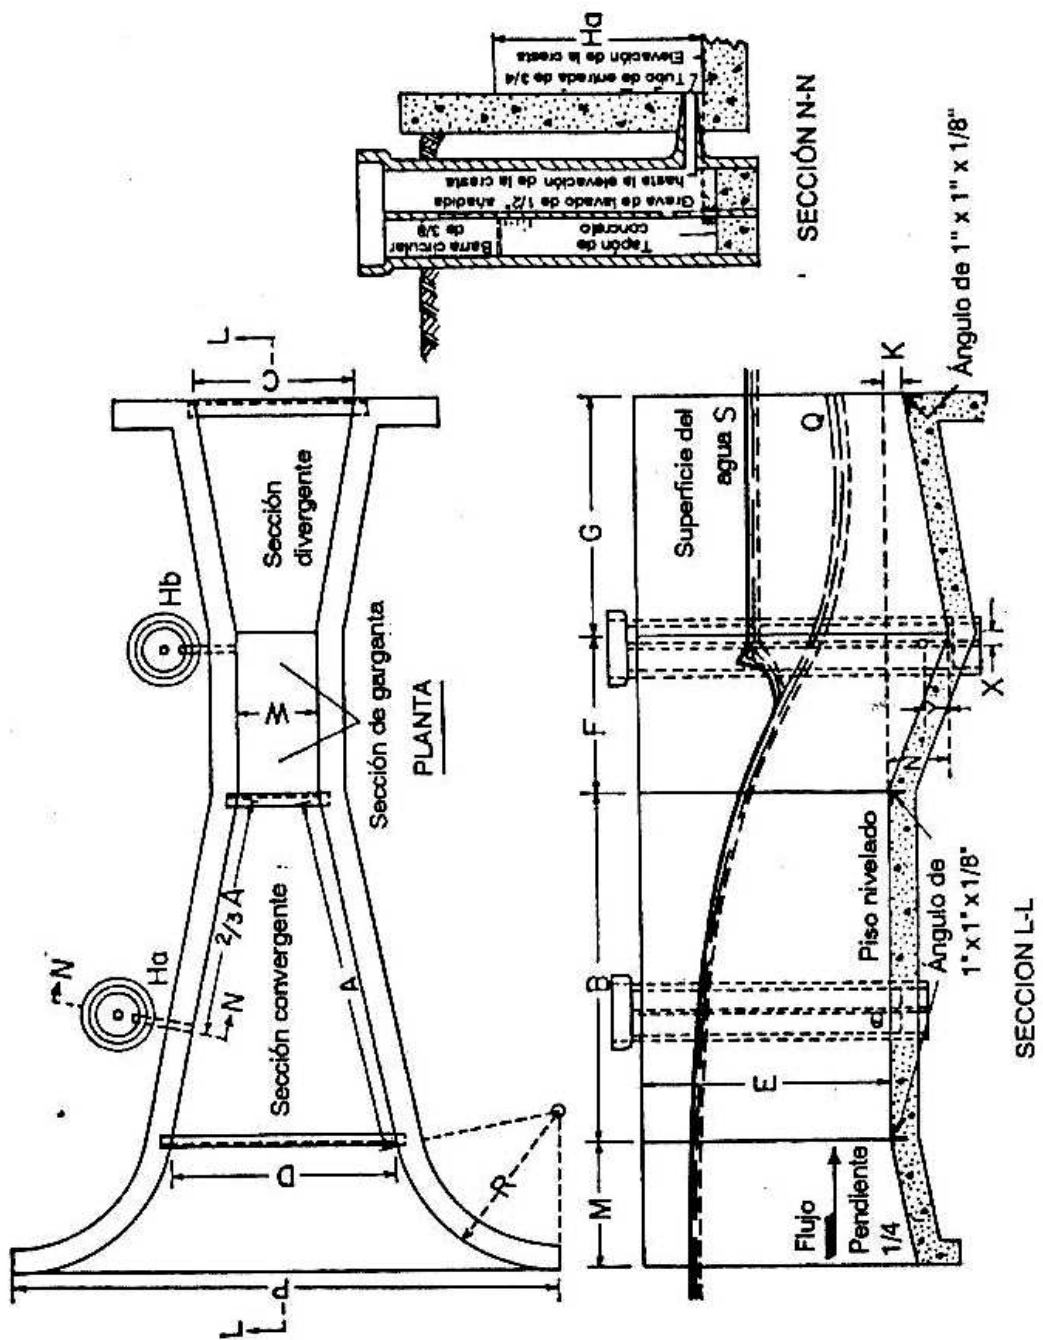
Planta, perfil y dimensiones de una canaleta Parshall.³¹
